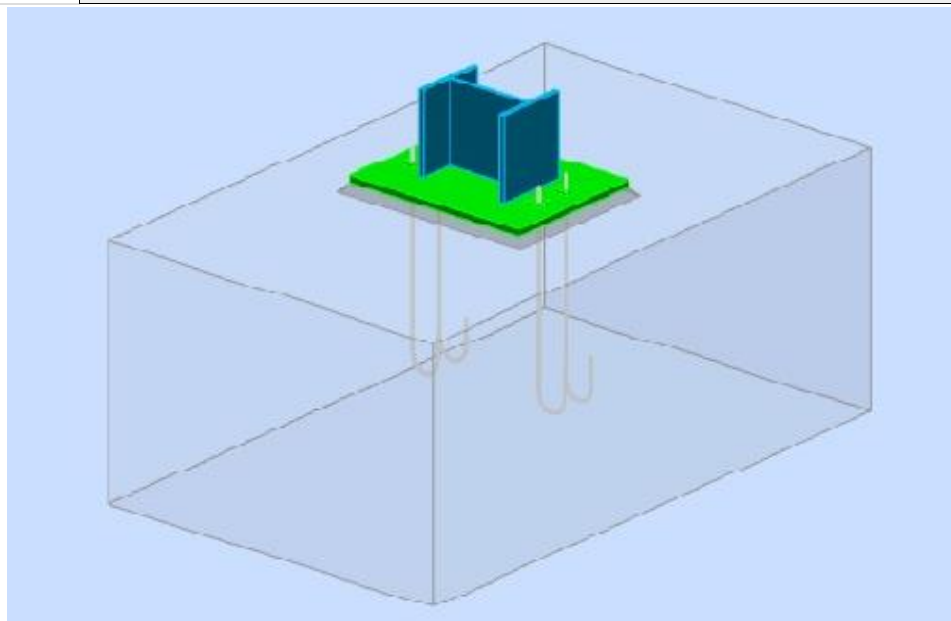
Vue 3D de l'assemblage au niveau du pied de poteau
